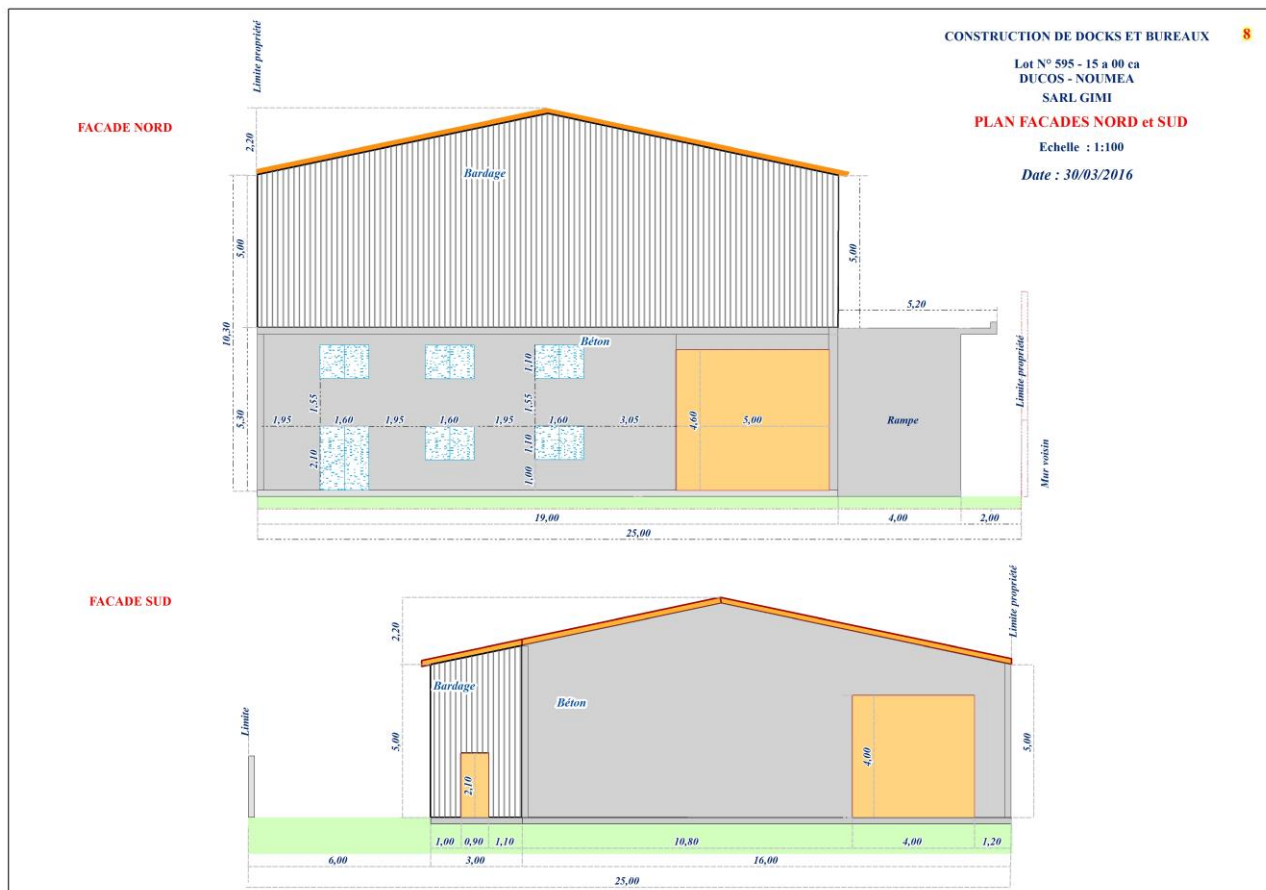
Coupes et plans façades du dock (RECY'GEM)
